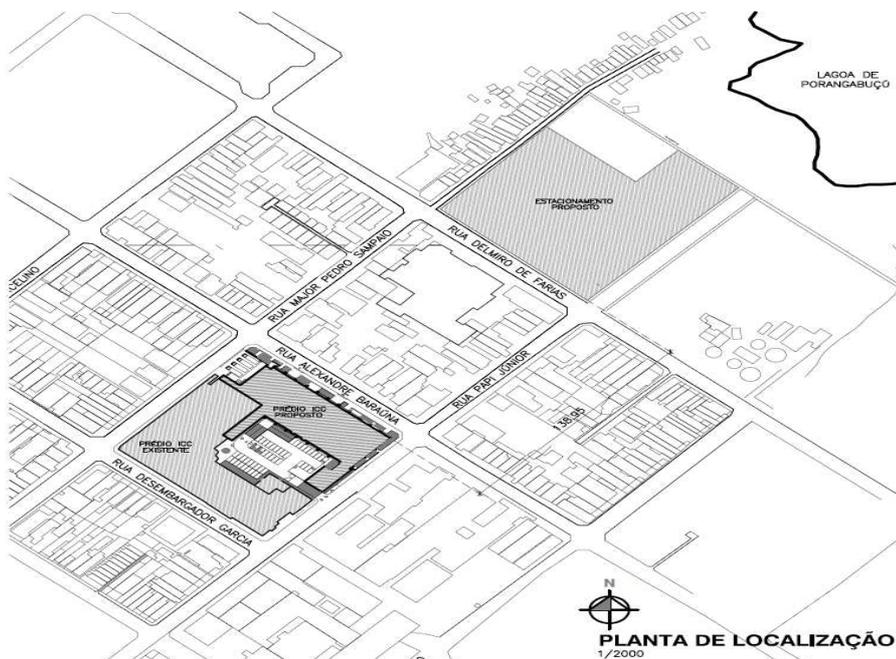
Planta de Localização. Fonte: Arquiteto Responsável
